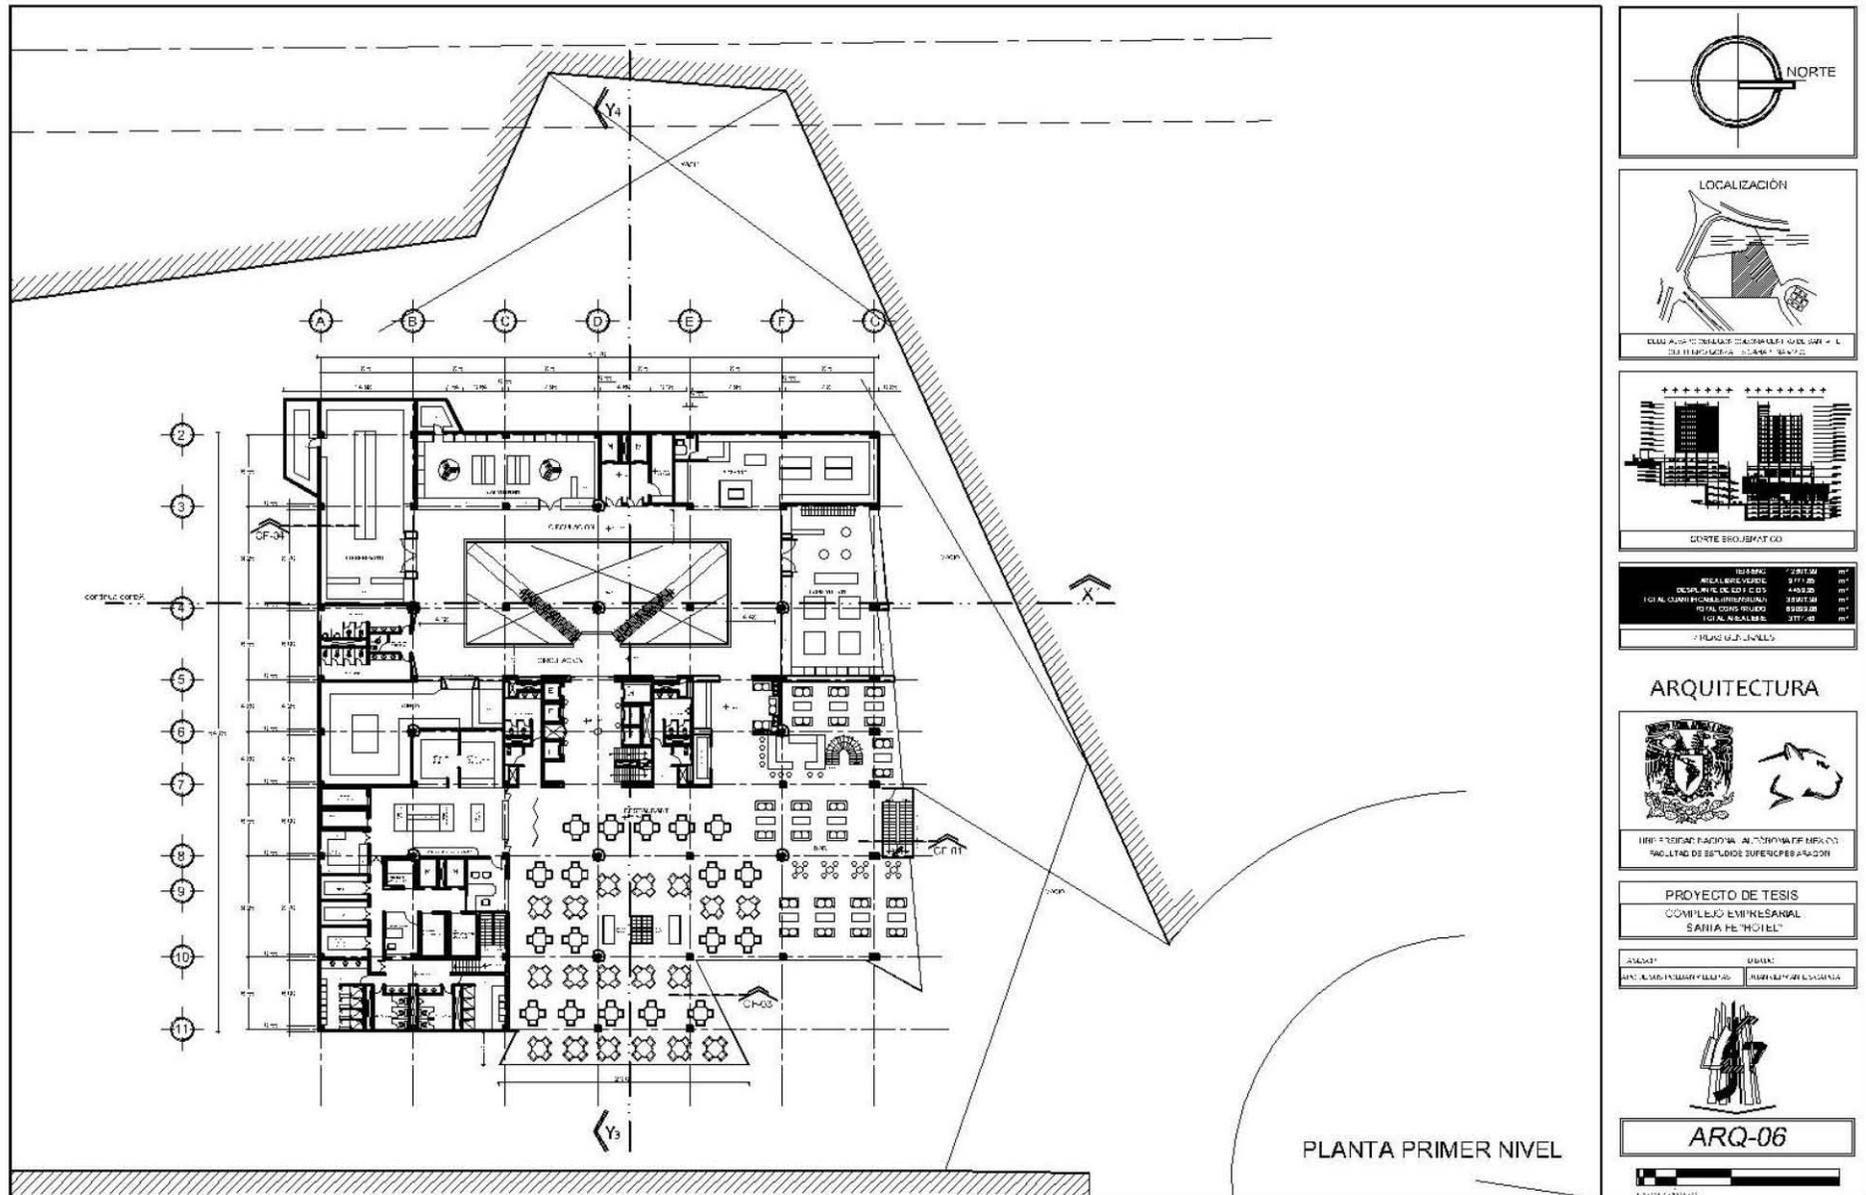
Plano ARQ-06; Planta Primer Nivel Hotel/Centro Comercial. Edición propia.
